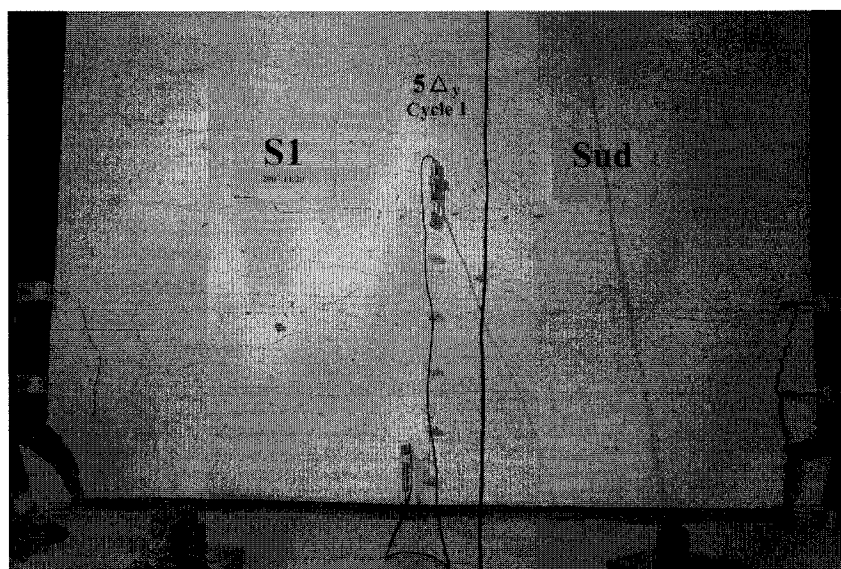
Photo de la face sud de S1 à la fin de l'essai (Boucher-Proulx, 2008)
